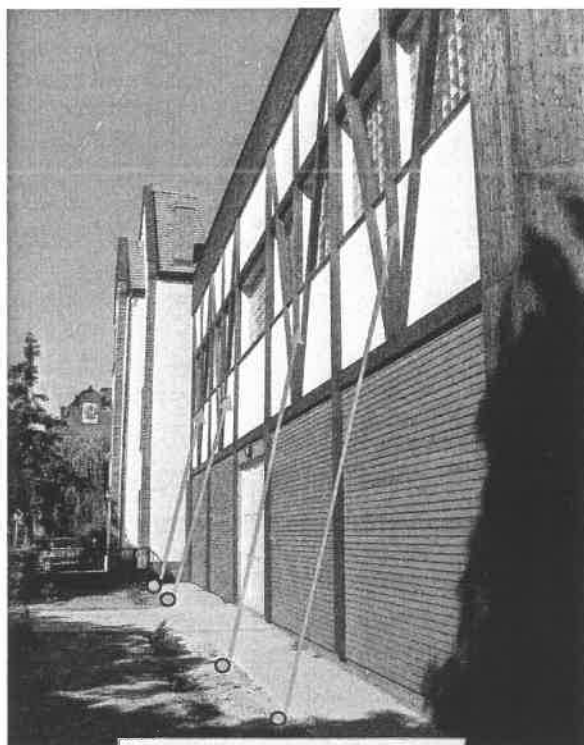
Rozmieszczenie opraw do iluminacji elewacji bocznej
